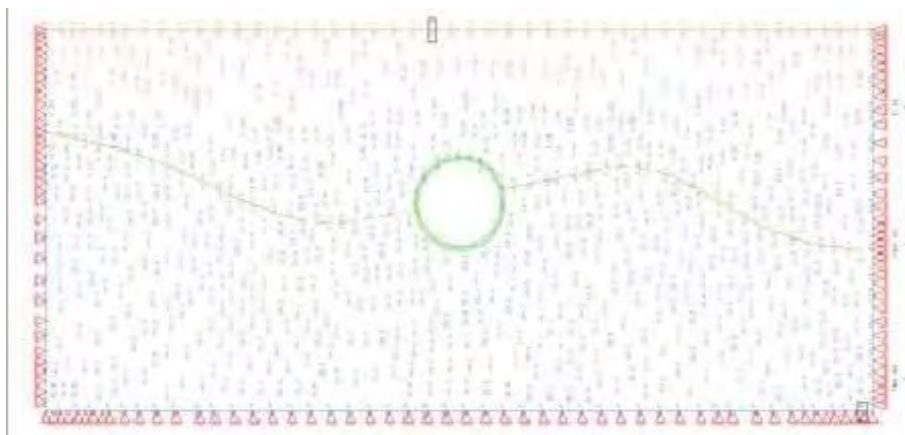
Нагрузки от давления грунта на конструкции тоннеля
